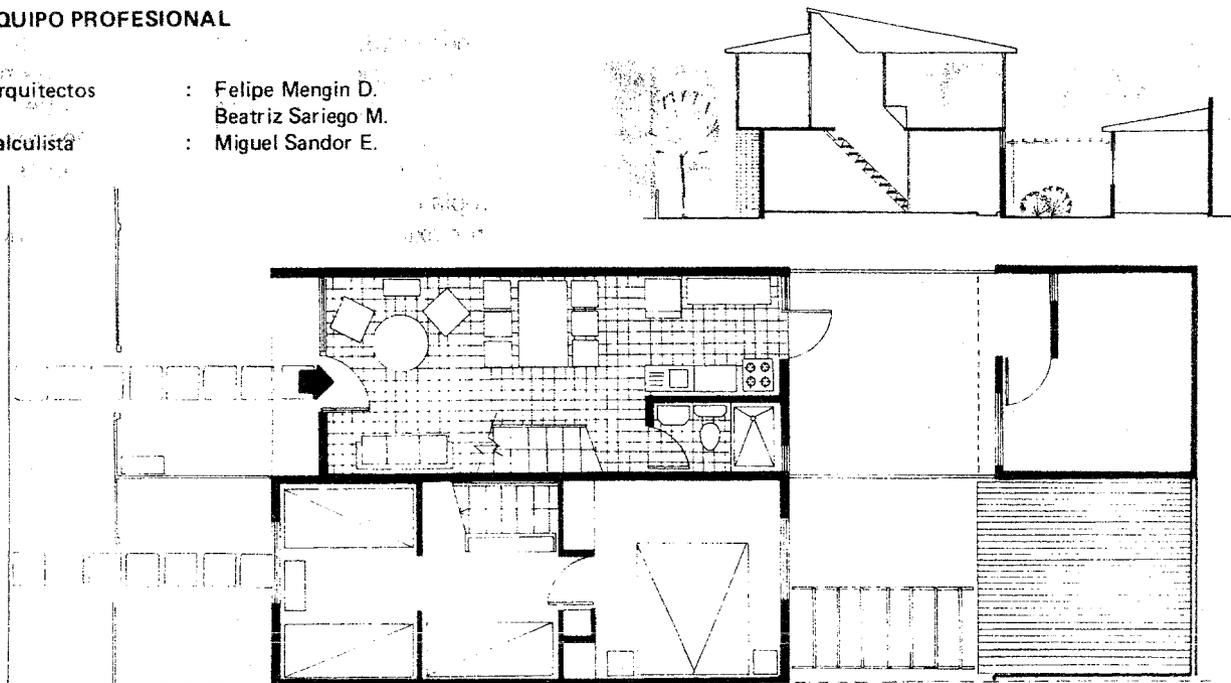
Prototipo de Vivienda Social construida por Empresa Constructora ARQUIN Ltda.
